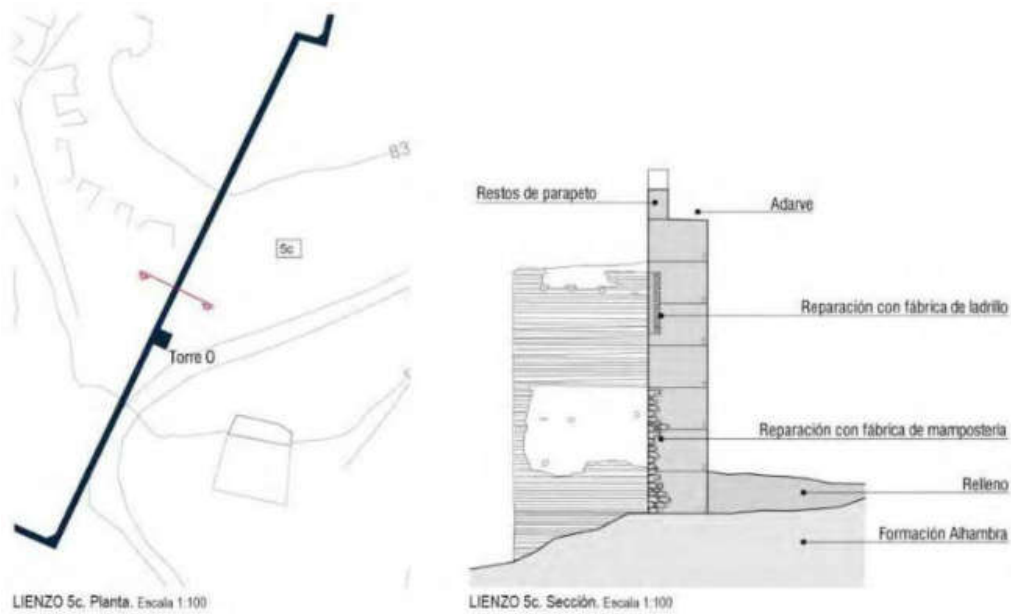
Sección de la muralla entre la torre O y el quiebro situado al norte.
